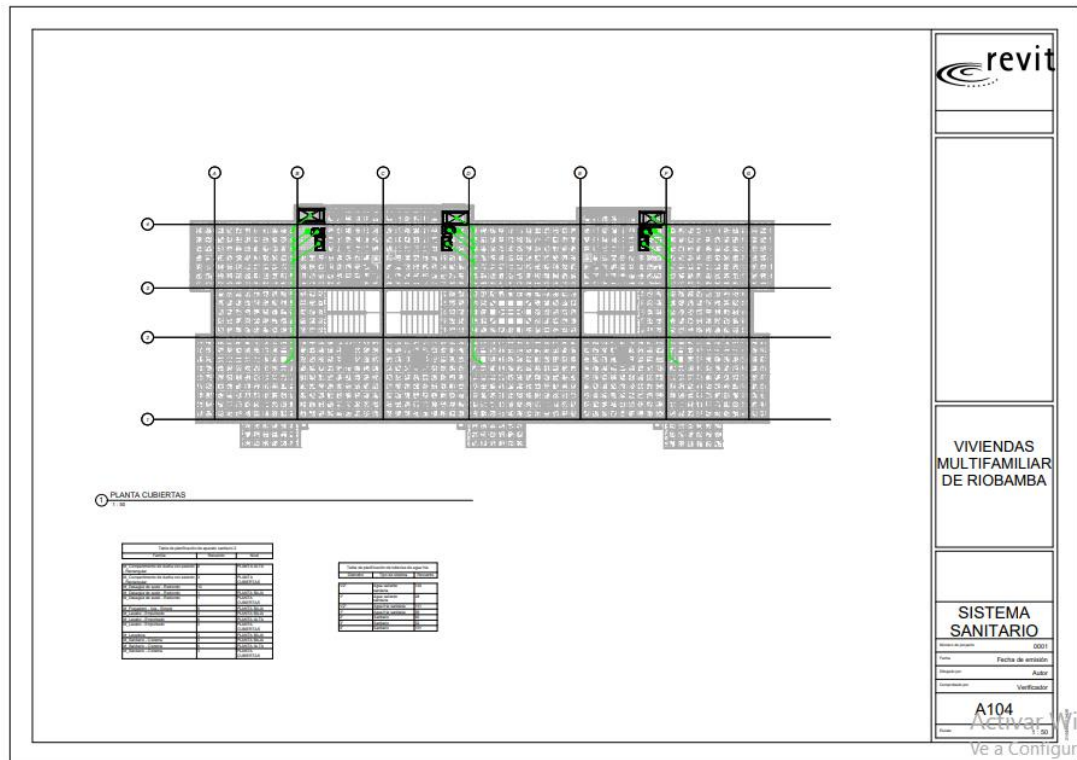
Plano MEP Hidrosanitario, Sanitario, Planta cubiertas
